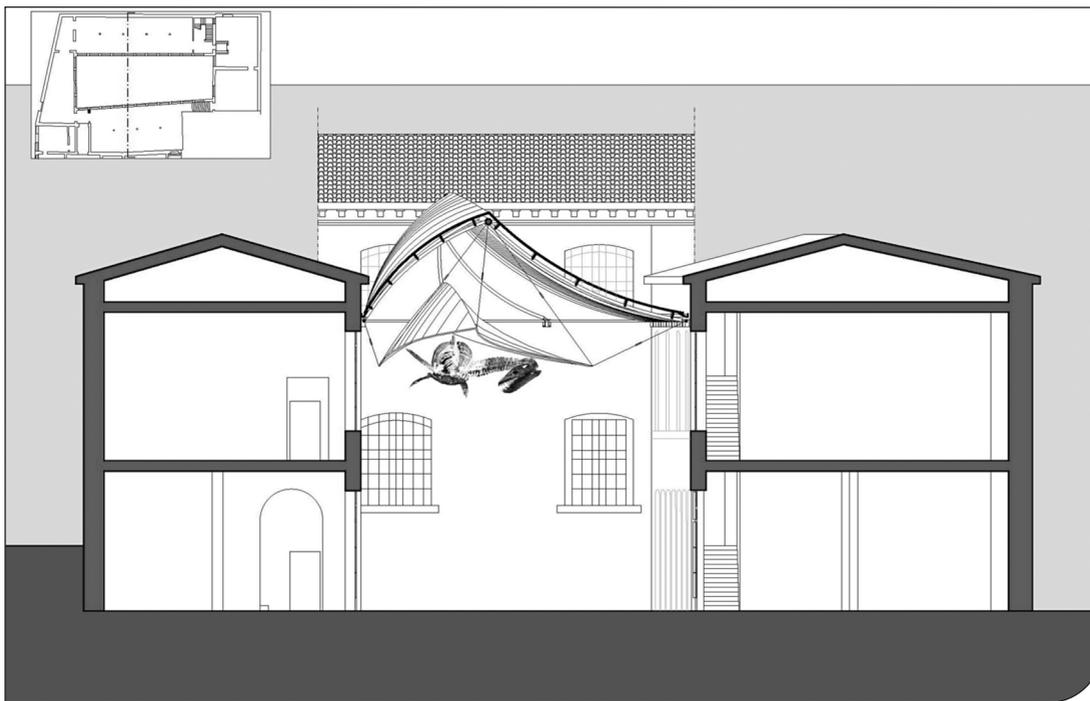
Progetto di copertura. Sezione A-A (vista prospetto sud).
